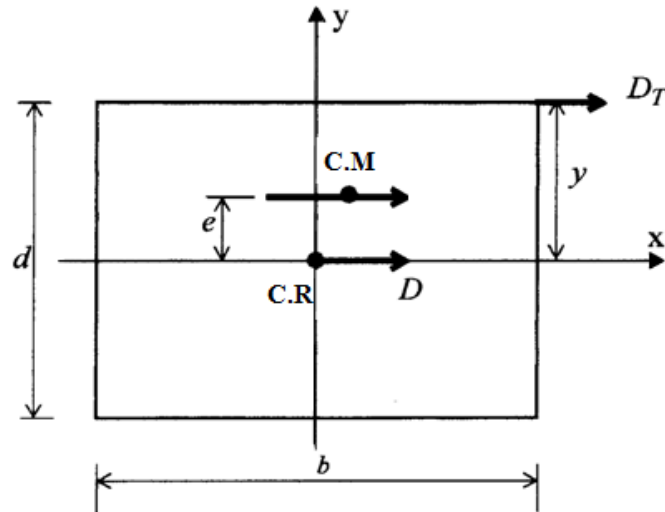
Dimensions en plan pour la détermination du déplacement total
